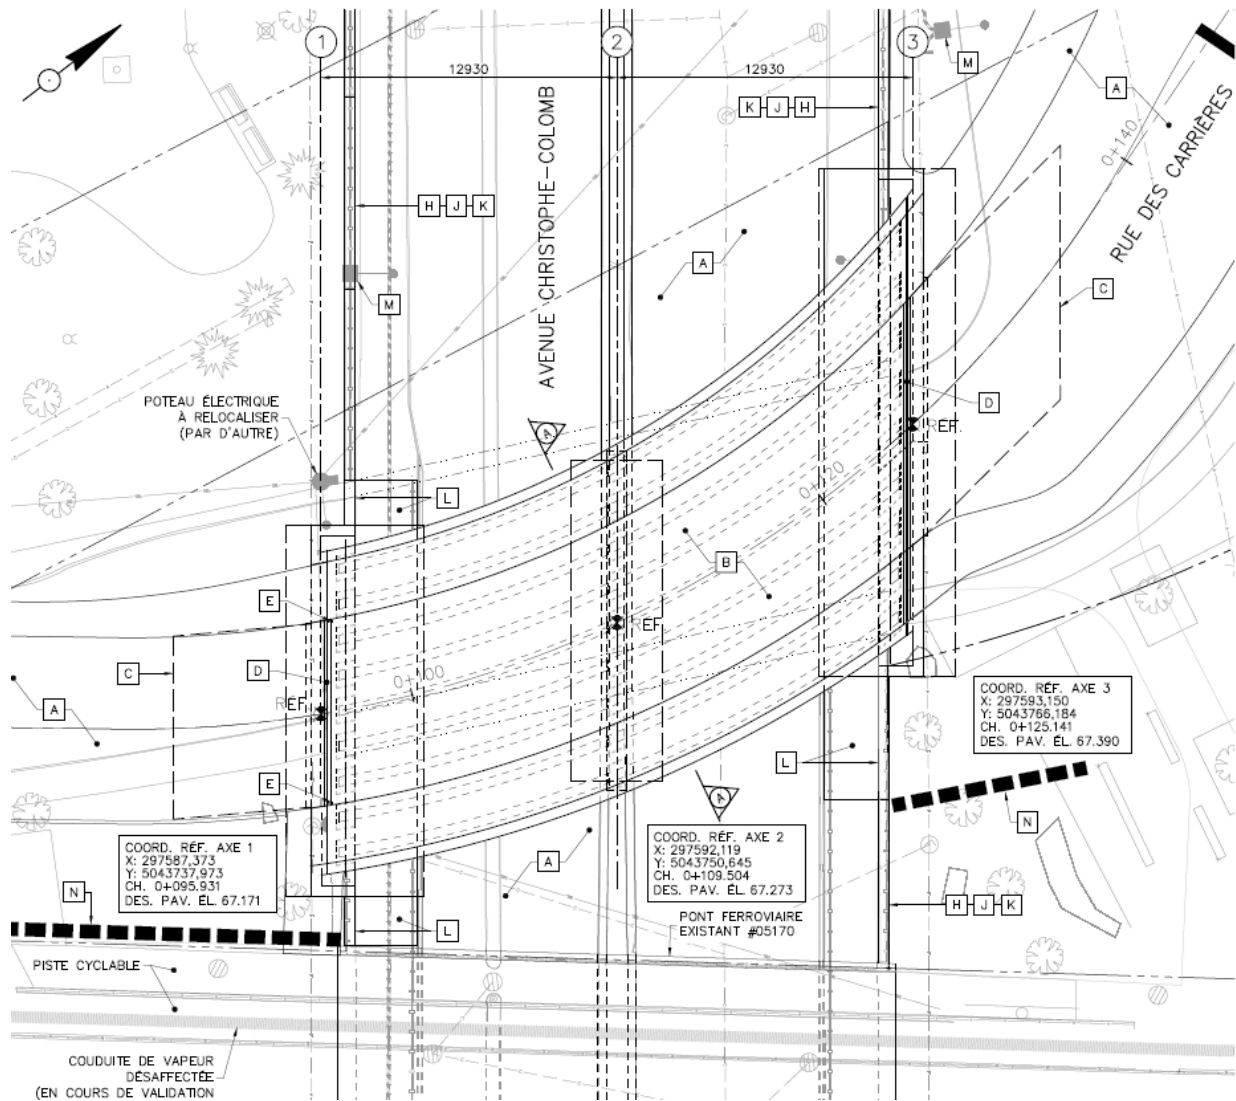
Extrait du plan d'ensemble du scénario 1 – Option poutres en acier – Vue en plan
